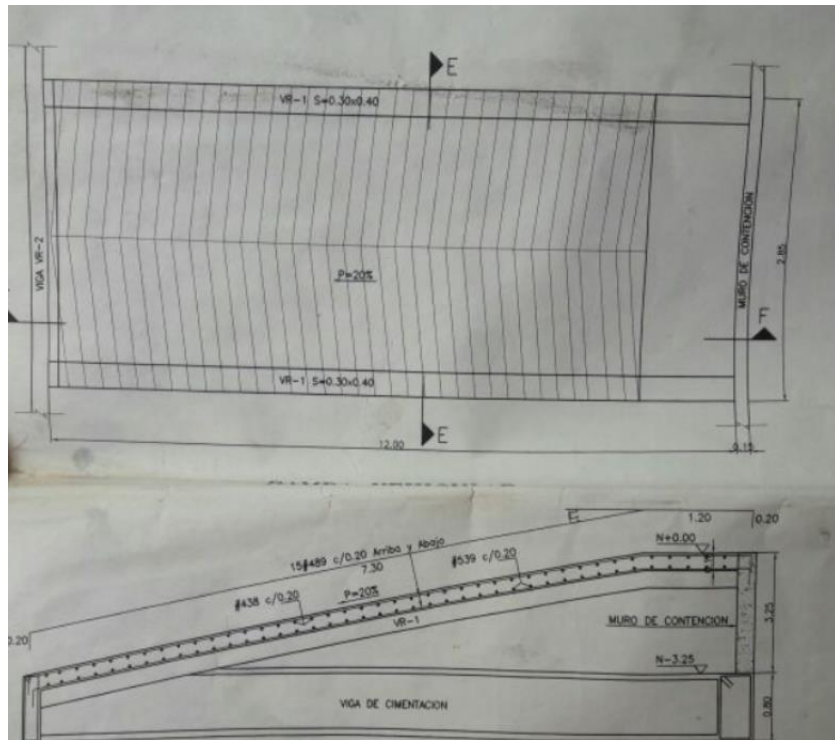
Detalle estructural rampa de acceso a parqueaderos: fuente: Camargo Construcciones.
